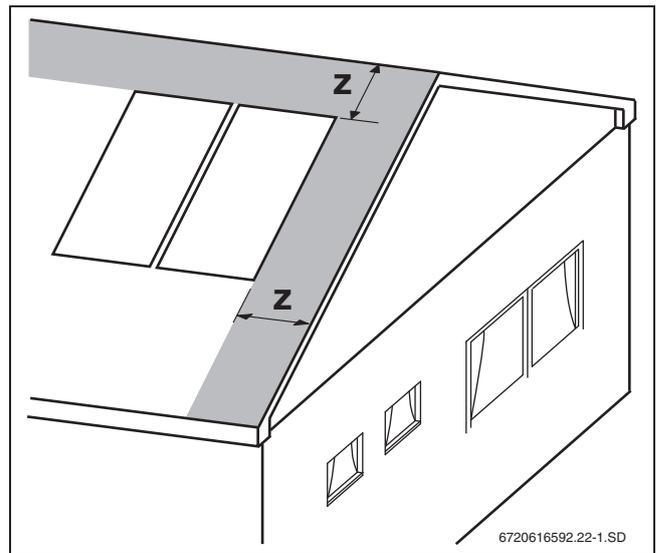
Distanza minima dall'area del bordo su tetti inclinati
